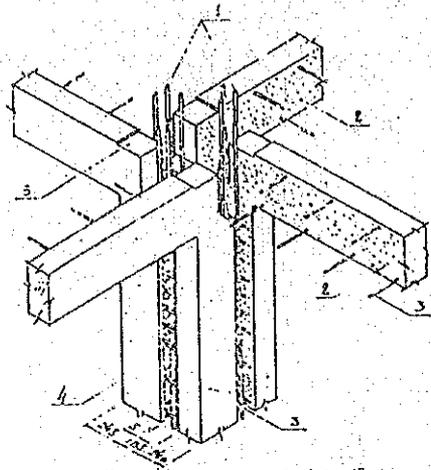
Конструкция железобетонных каркасов одноэтажных промышленных зданий с кранами и без кранов.
